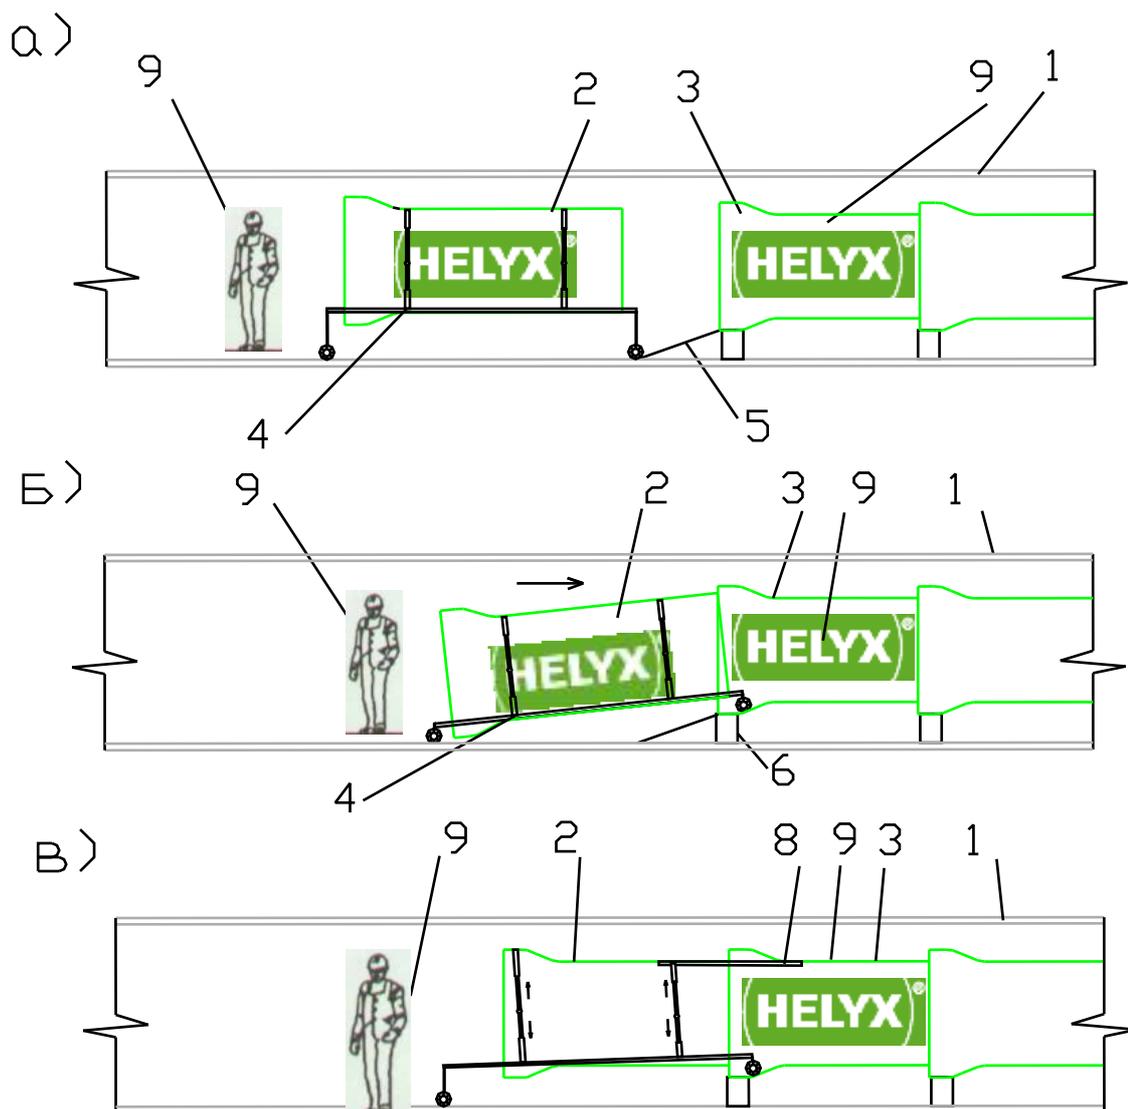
Установка трубы на месте монтажа с использованием тележки
